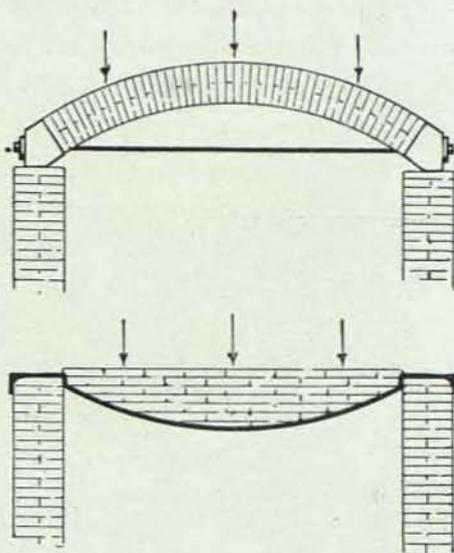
Principio de la división del trabajo, á tenor de las máximas resistencias de los materiales, aplicado á estructuras en ladrillería.
